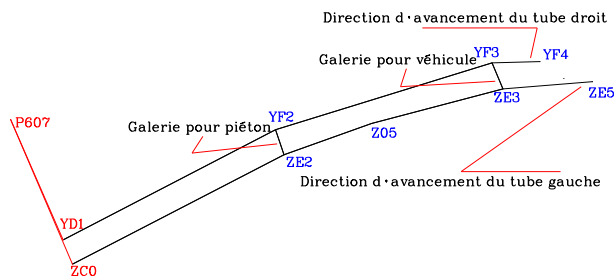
Plan du cheminement à la sortie sud du tunnel T1
